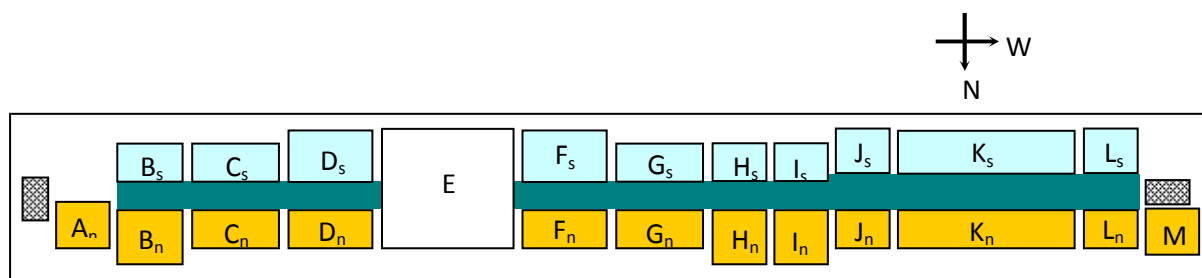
SCHEMA PLAN DU CA-MET ⁵
